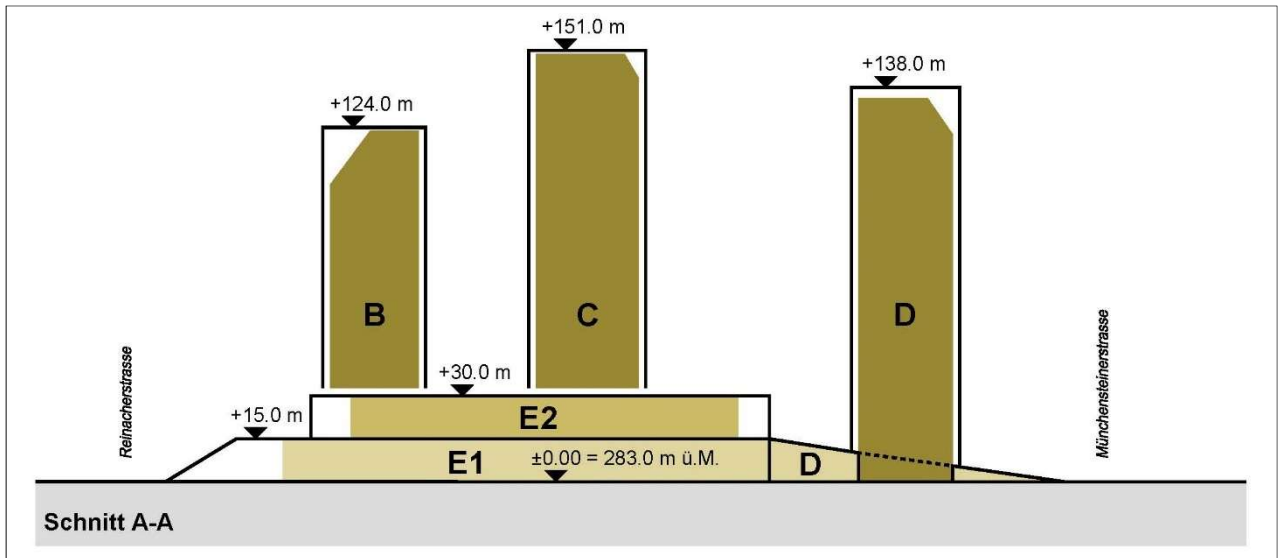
Bebauungsplan Schnitt A-A. (Kein Massstab)
